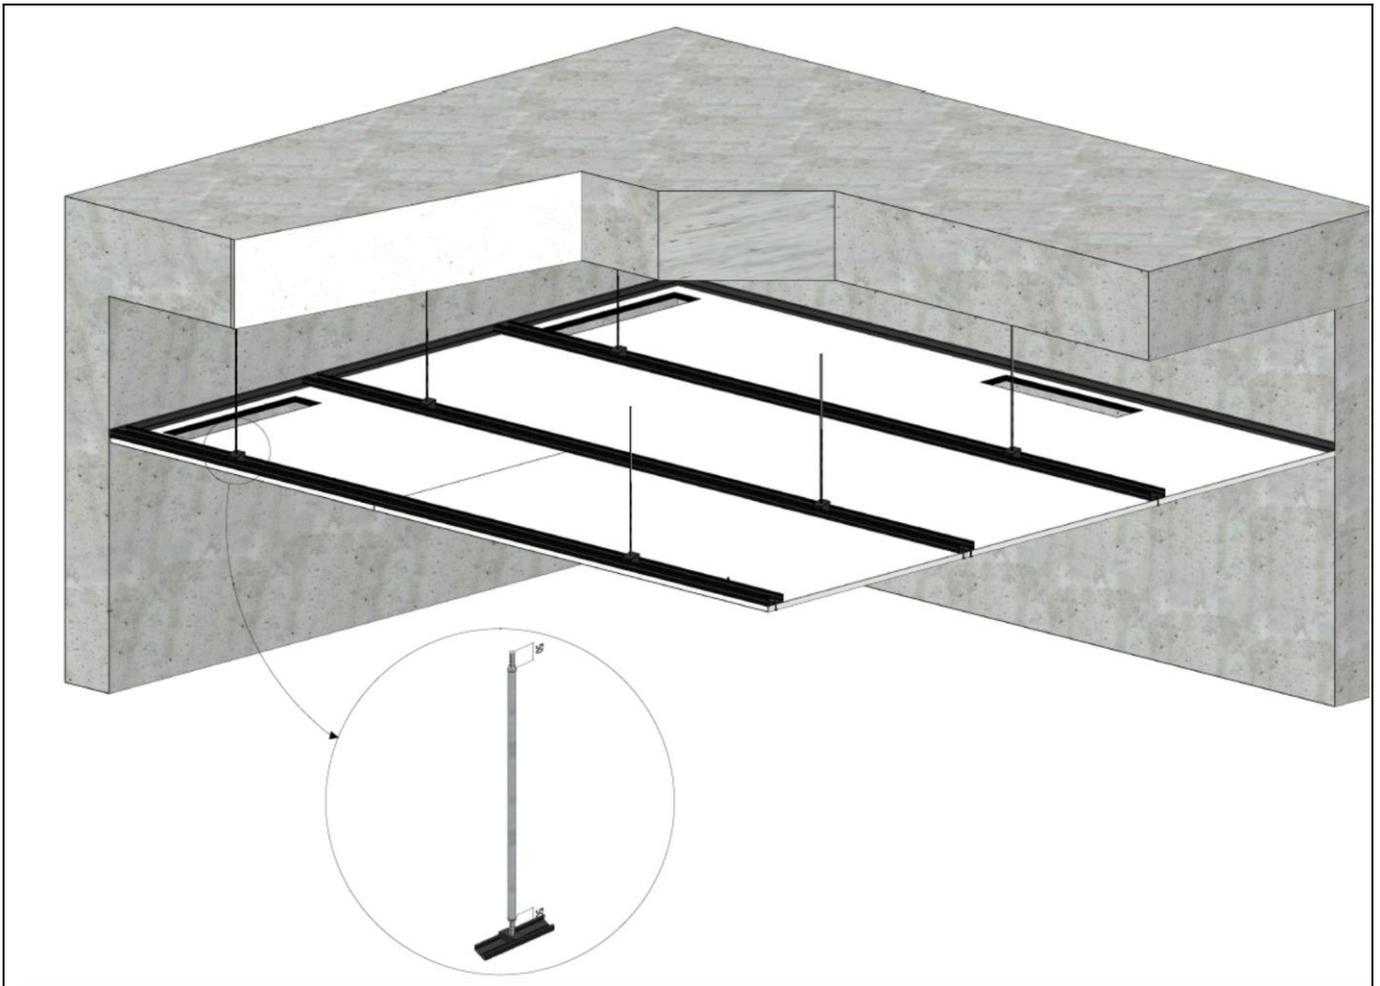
Plafond extérieur Hydrodroof_suspente pivot avec tube (butonnage)
